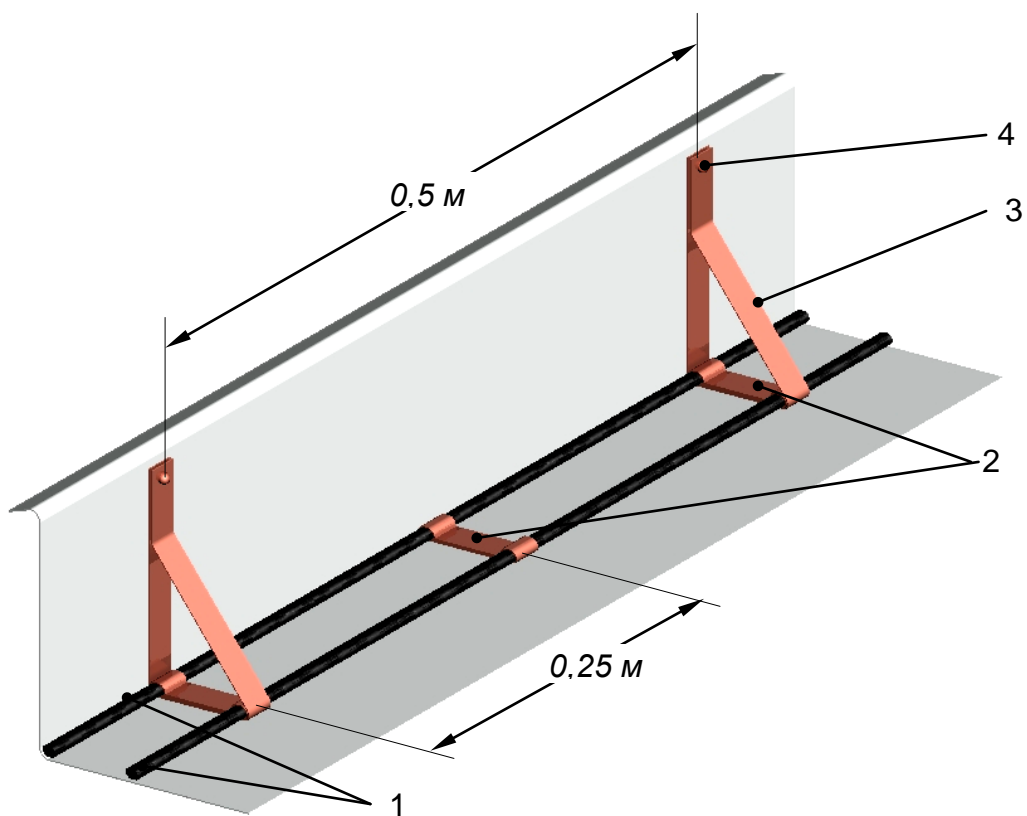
Крепление двух ниток нагревательного кабеля в желобе.
